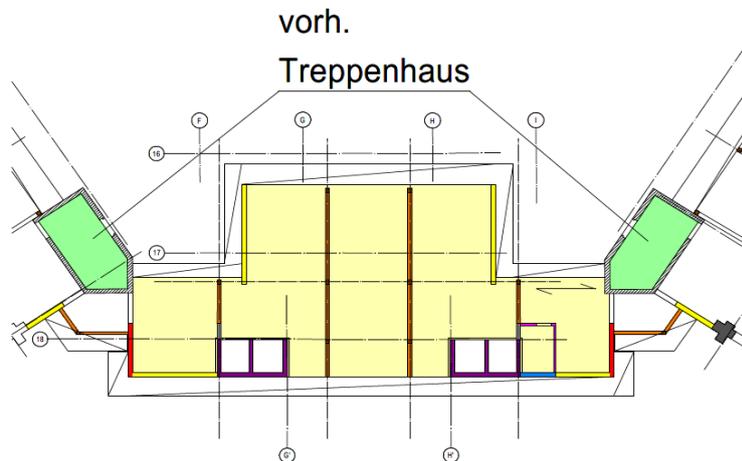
Grundriss Mitteltrakt Dachgeschoss [Walter Reif Ing. GmbH]
